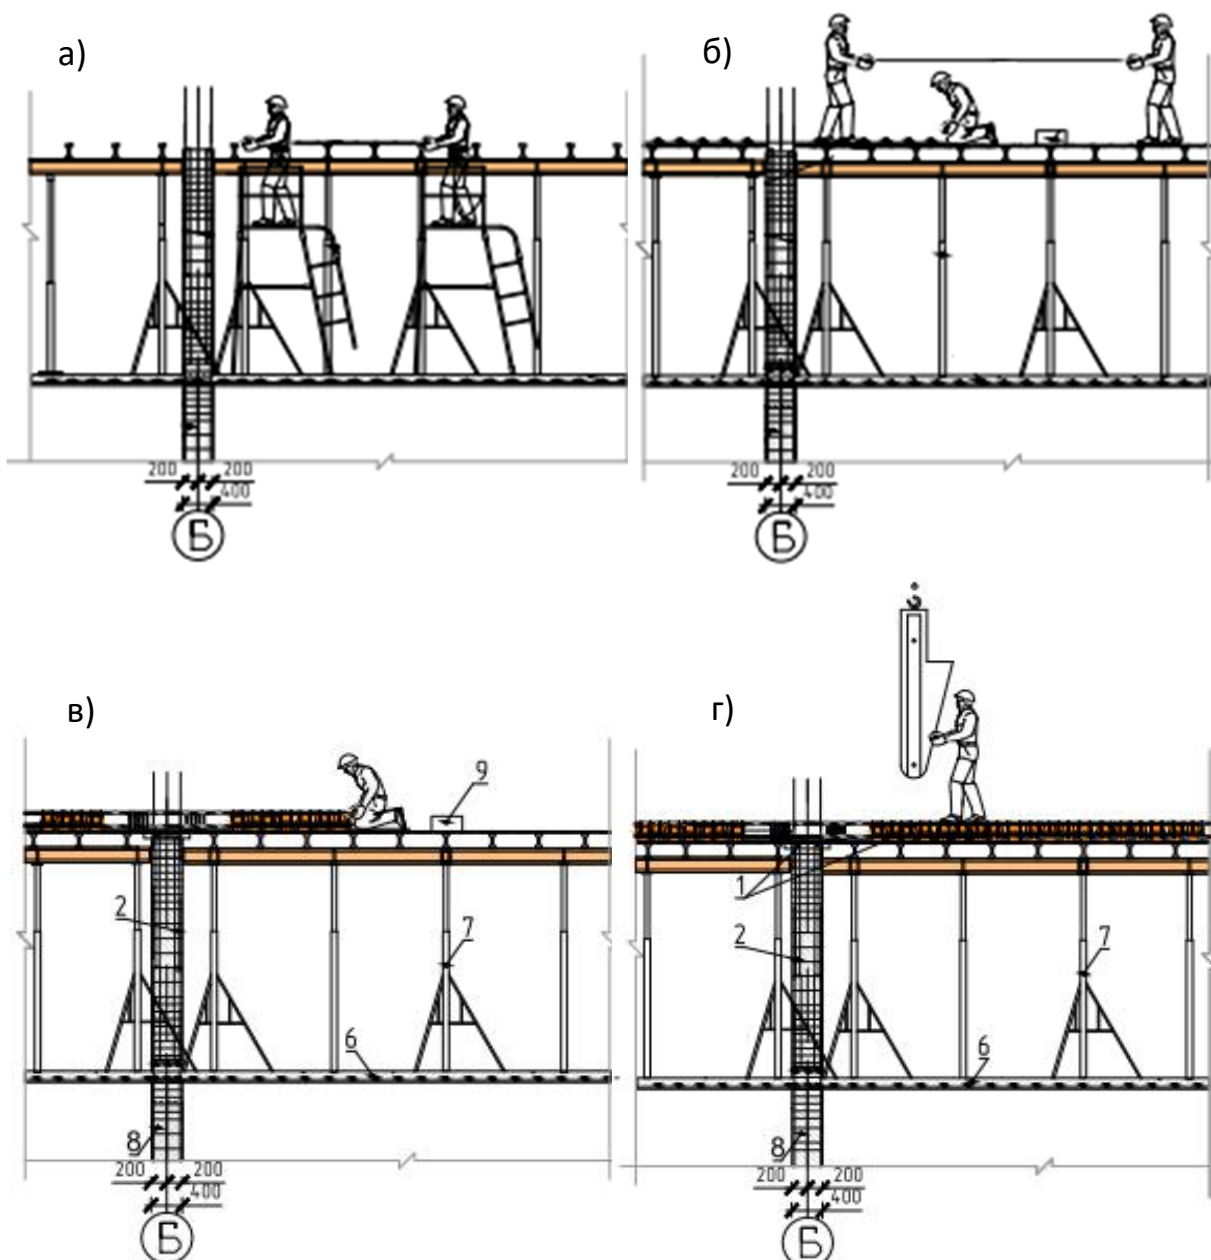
Этапы возведения облегченного сборно-монолитного перекрытия конструкций железобетонной плиты с пустотообразователями:
